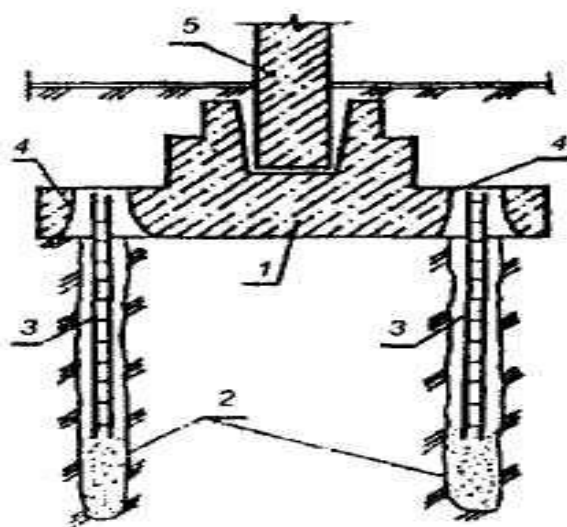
Передача нагрузки от отдельного фундамента на буроинъекционные сваи
